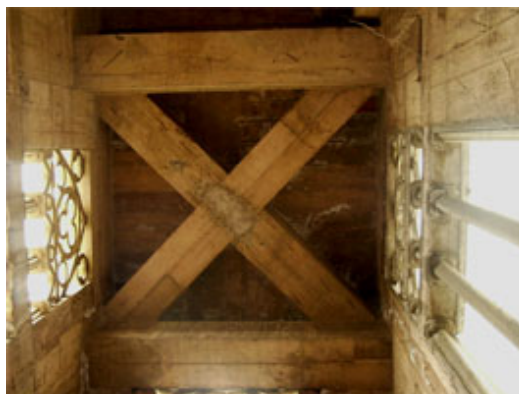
Cruces de vigas de arriostramiento y elementos prefabricados en cerramiento.
